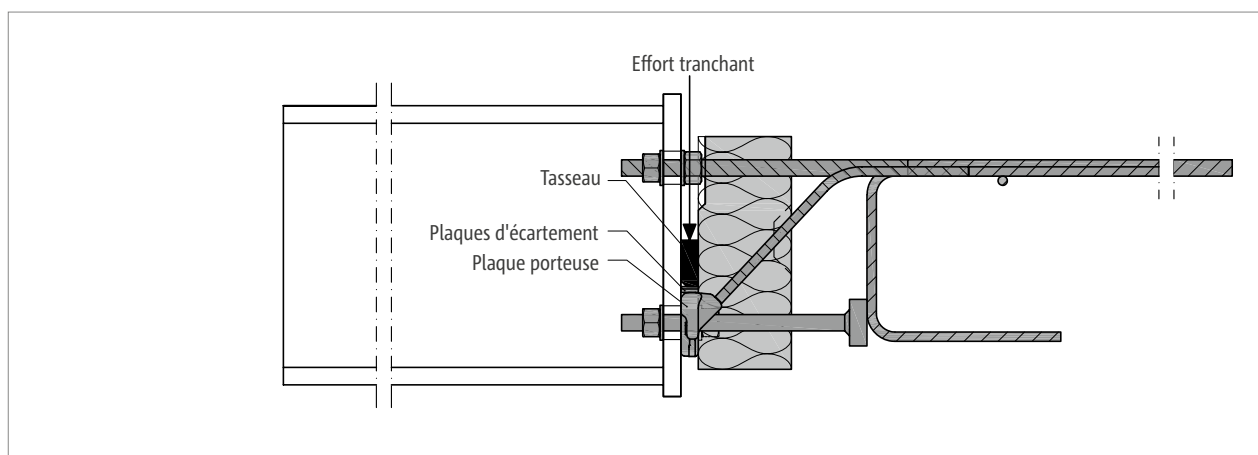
Schöck Isokorb® T type SK : taquet fourni par le maître d'ouvrage pour le transfert de la force transversale
